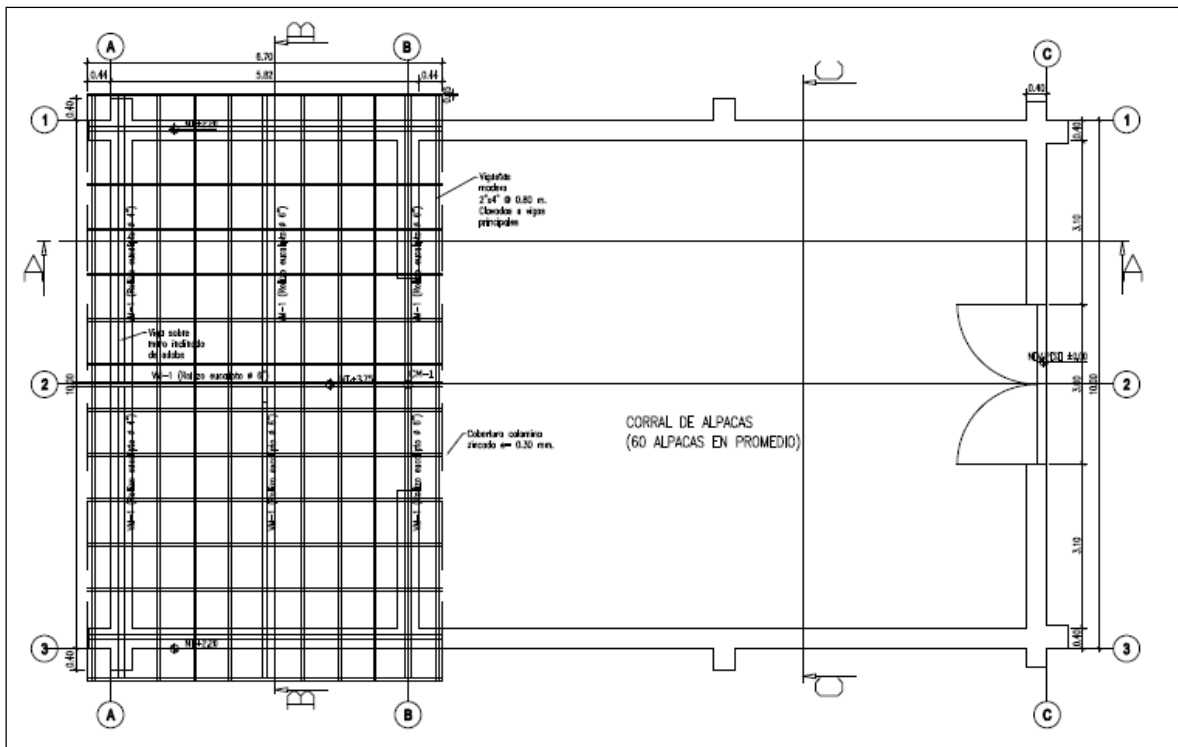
Plano en Planta Cobertizo diseño 03, Nuñoa, Puno
